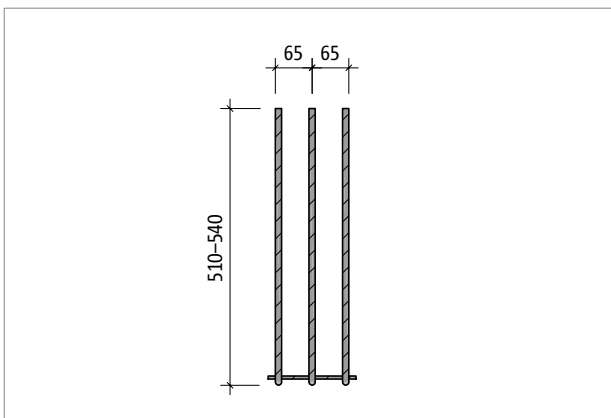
Schöck Sconnex® Typ W Part TB: Zulagebewehrung 3 Ø 12/65 mm; Bügel in der Seitenansicht
